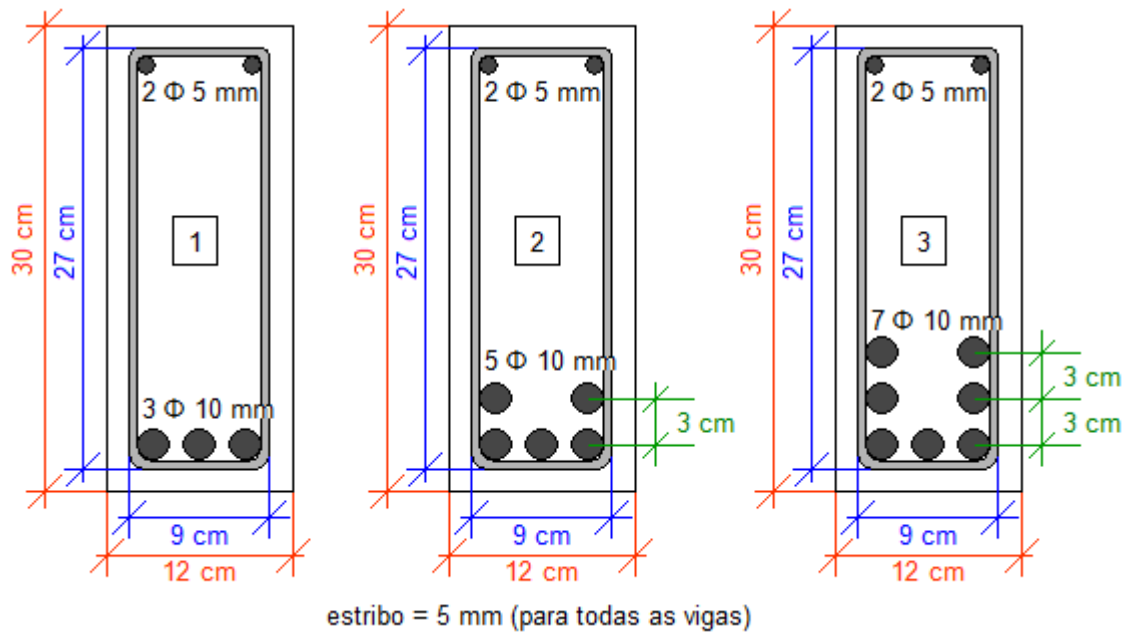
Armadura das vigas ensaiadas por Álvares (1993).
